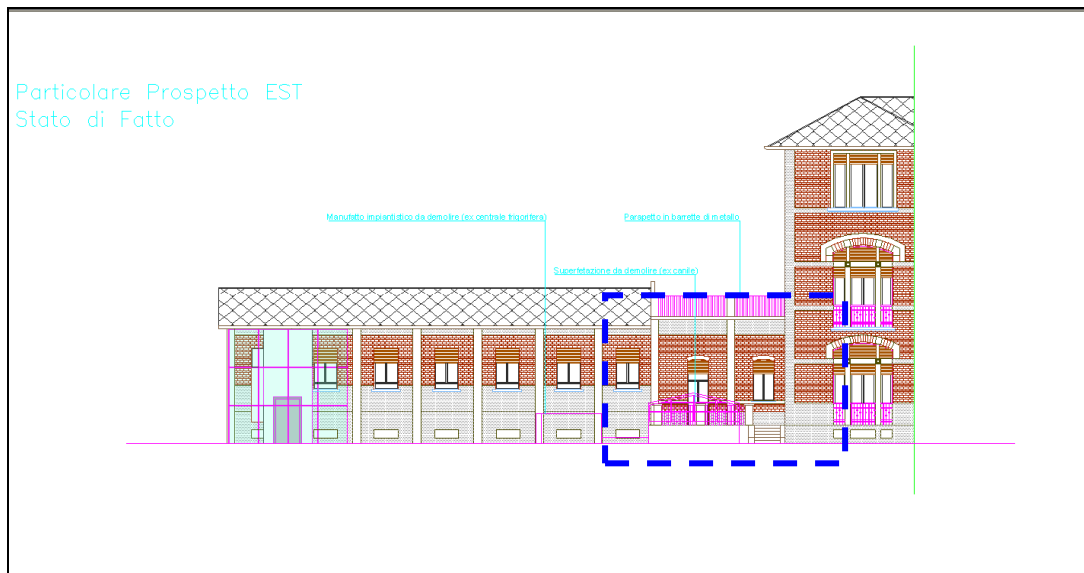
Prospetto raffigurante lo stato di fatto e di progetto dell'intervento di ristrutturazione
